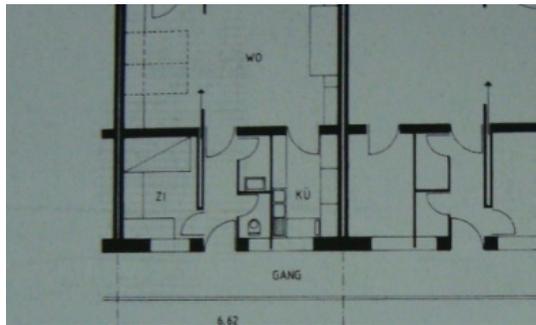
Siedlung Praunheim, Frankfurt, Planta do apartamento tipo de 41,50m²
